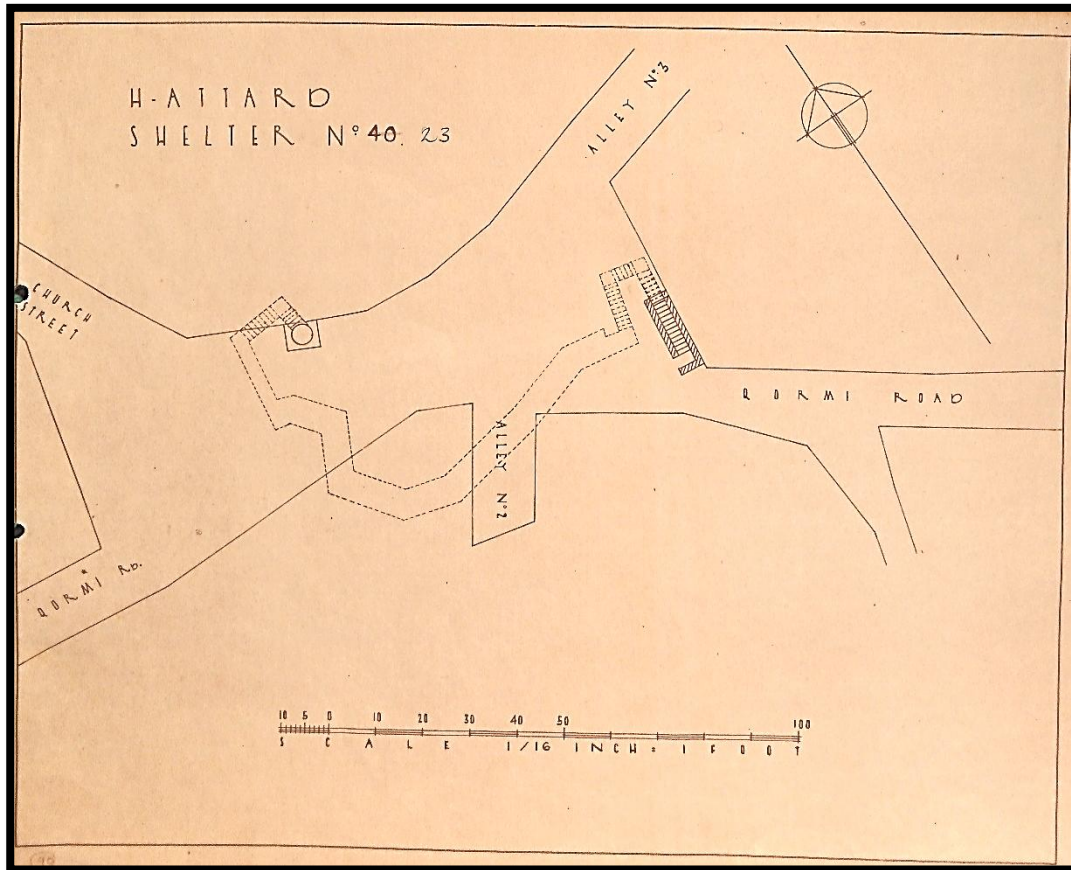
Planta do Abrigo nº23 (40) "Alley nº3 – Qormi Road – Church Street"
